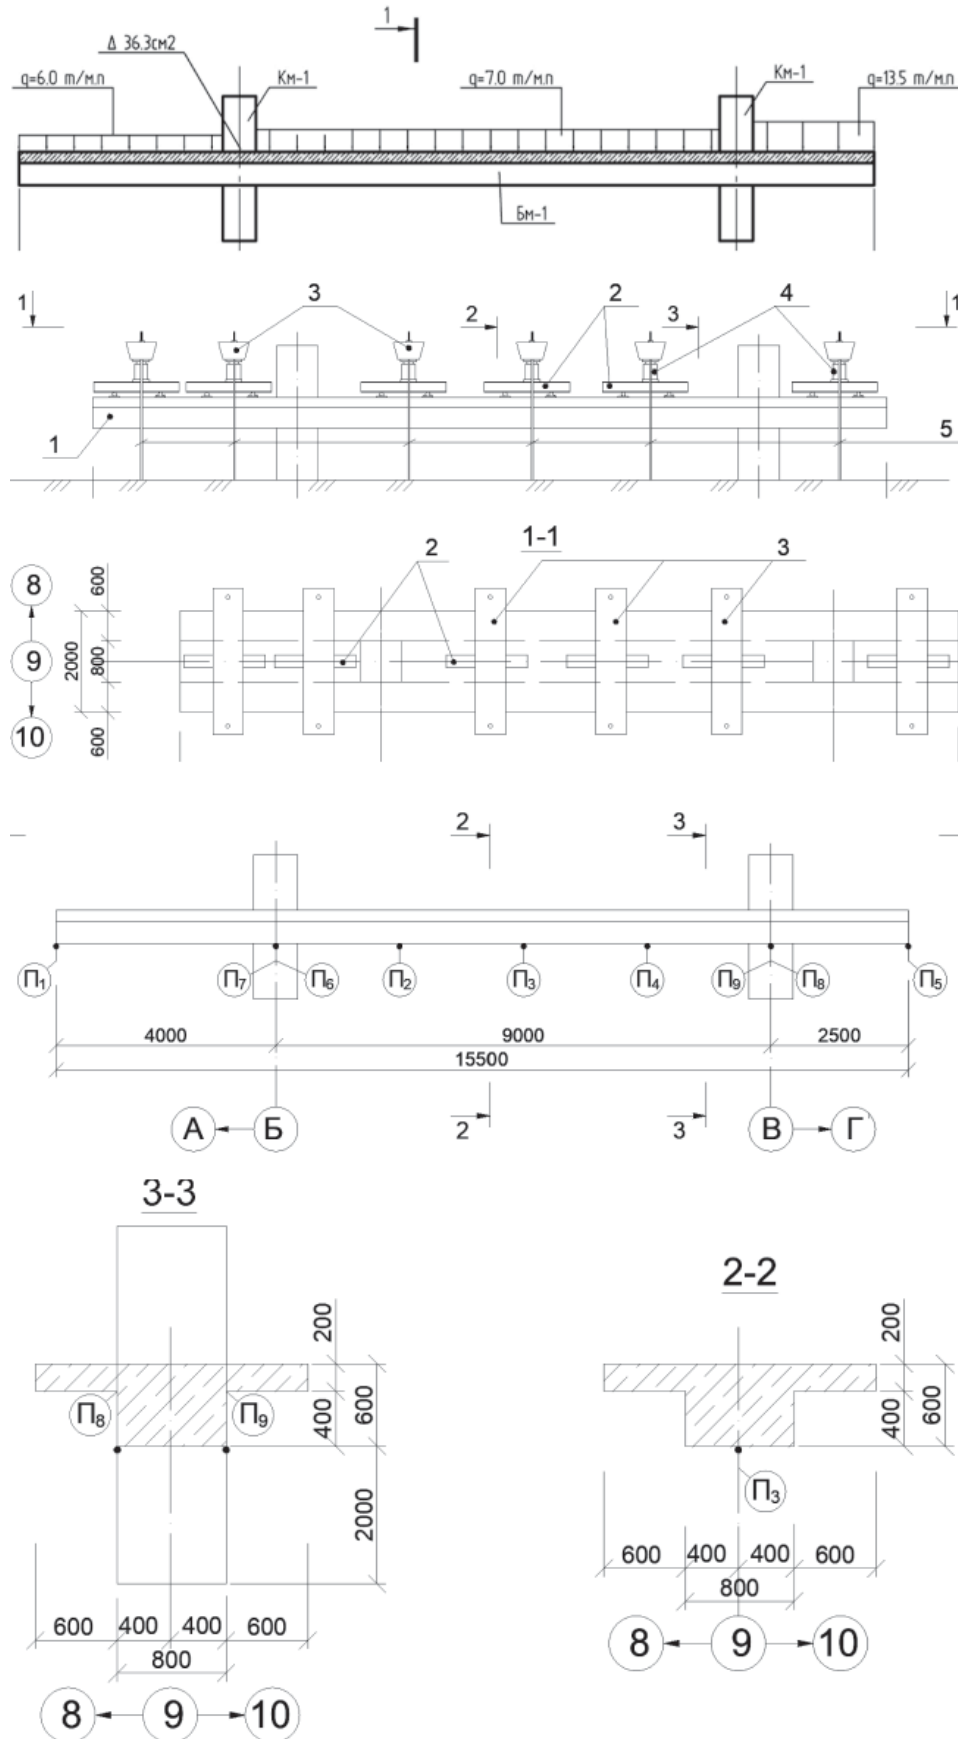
Схема прикладення навантаження і значення навантаження на зразок балки (а); розташування навантажувального обладнання на зразок (б): 1 – зразок балки; 2 – розподільчі балки; 3 – траверси; 4 – гідравлічні домкрати; 5 – тяжі-стійки; розташування вимірювальних приладів (в): П1-П9 – прогиноміри БПАО
